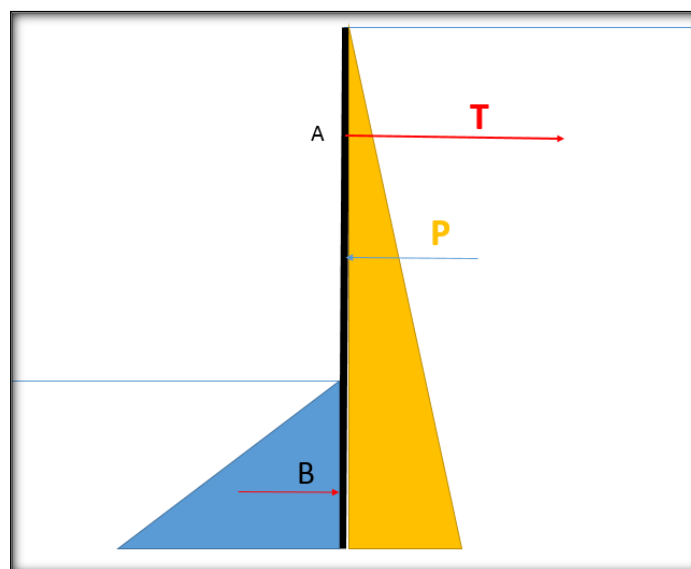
Schéma d'un rideau travaillant en butée simple
